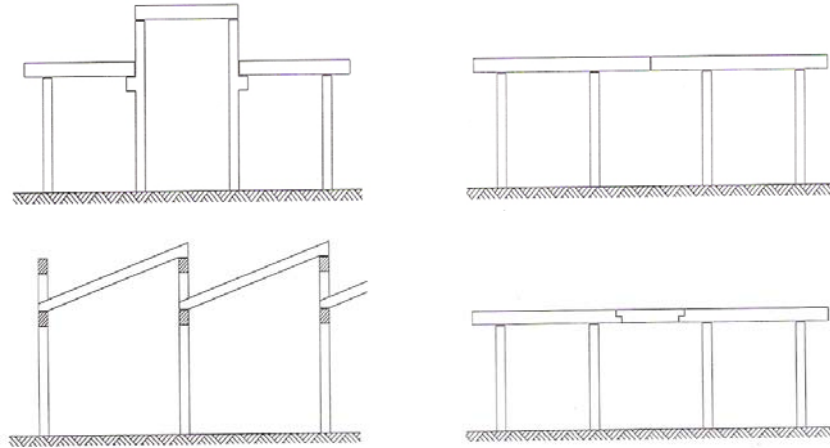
Esquemas construtivos com elementos de eixo reto.
